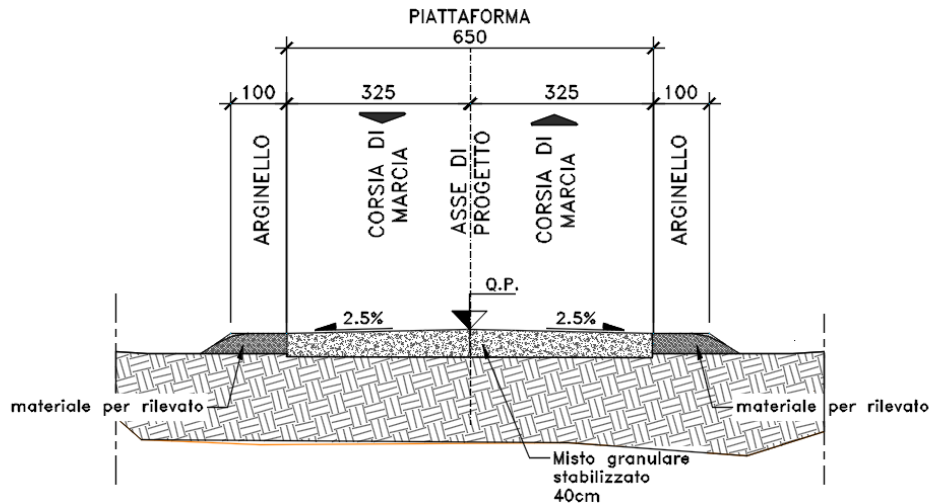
SEZIONE TIPO STRADE DI CANTIERE
